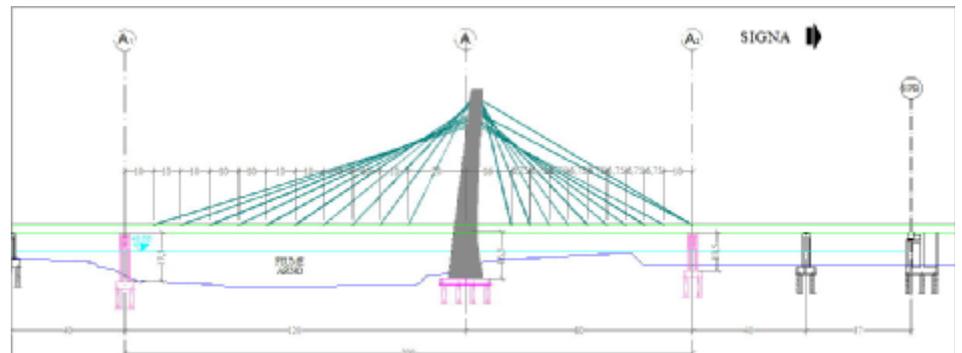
Vista prospetto altimetrico della soluzione adottata
